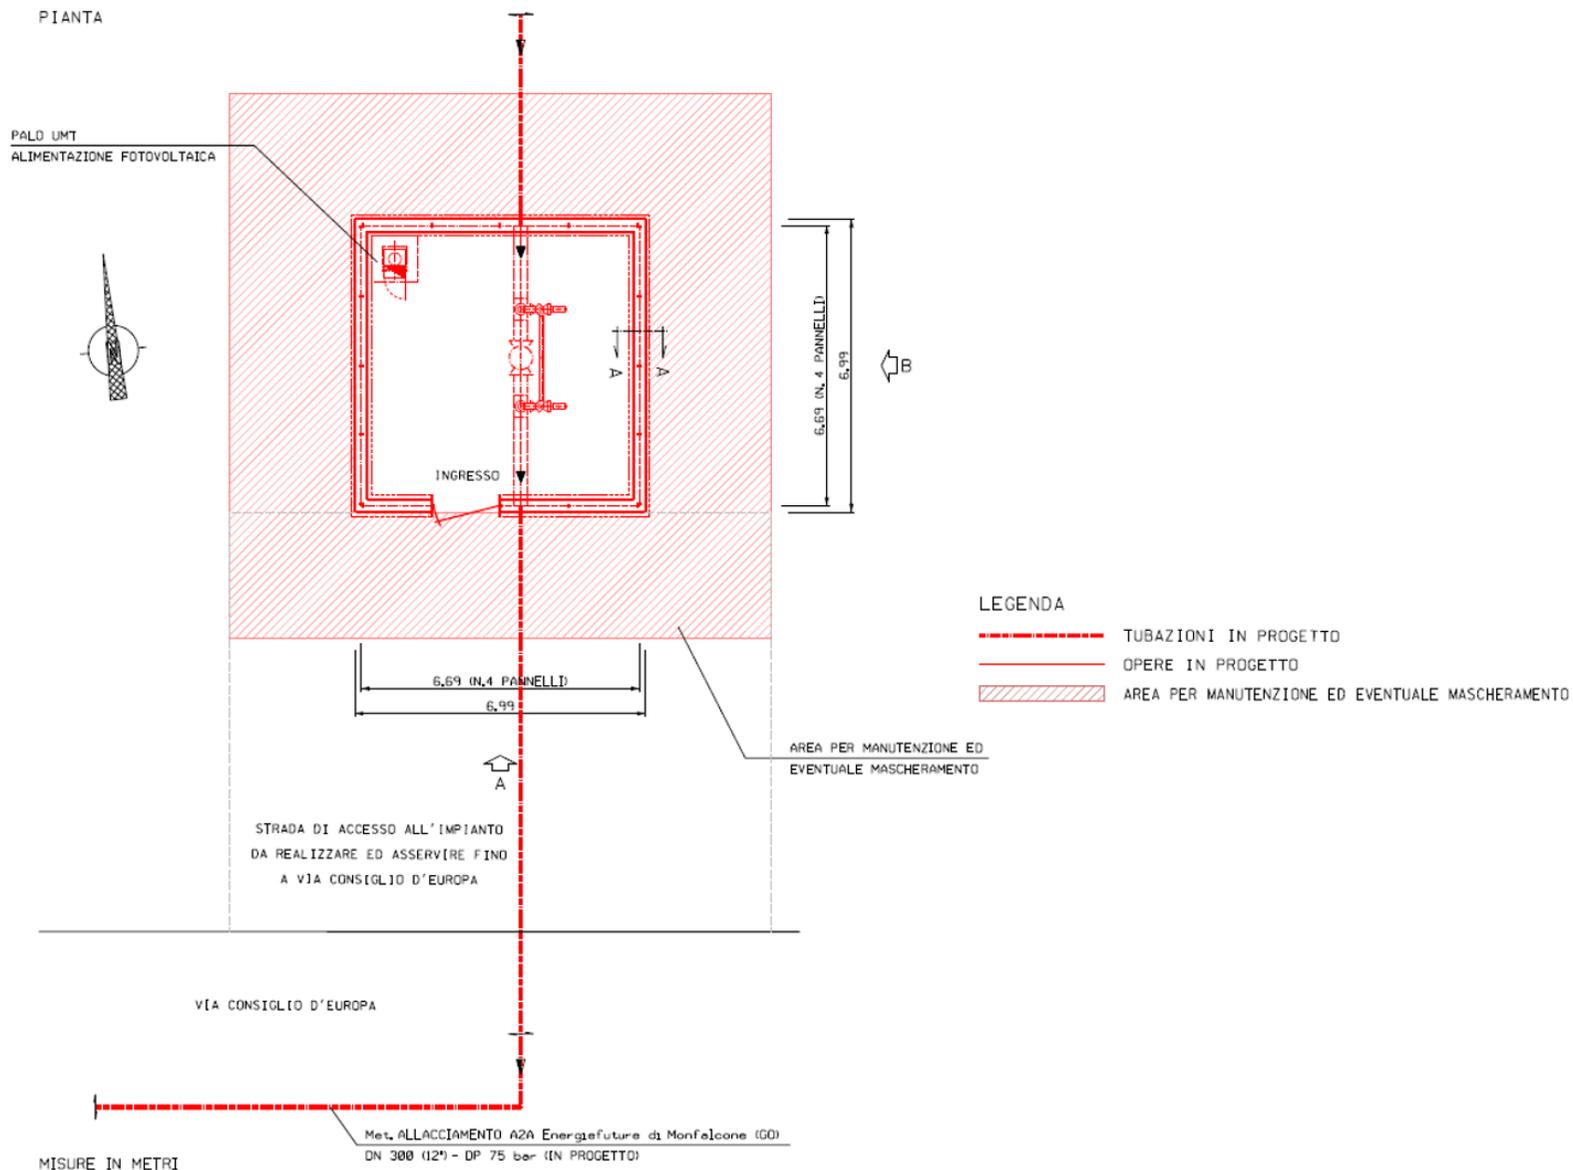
Planimetria del nuovo punto di intercettazione di linea n.2 (P.I.L. n.2)
